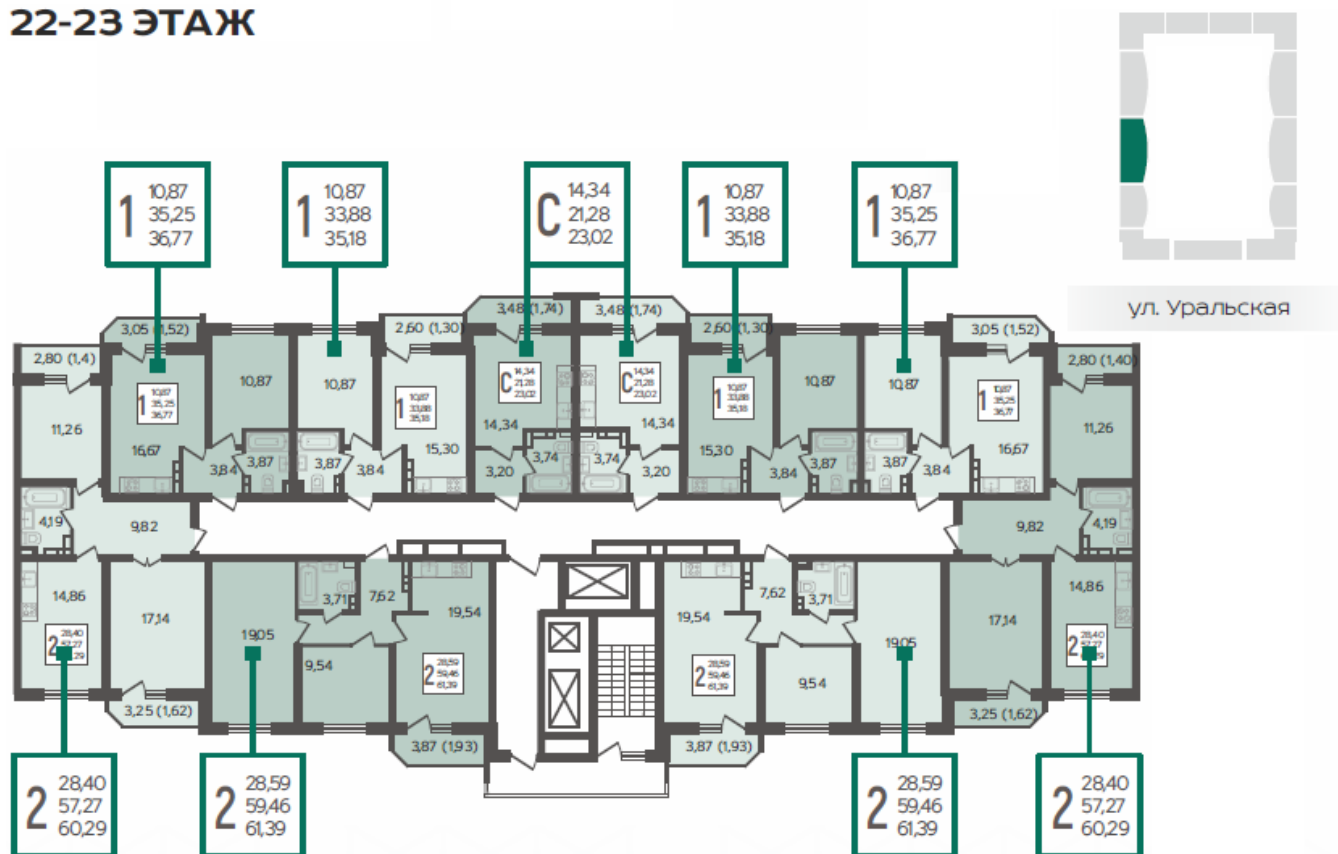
Типовой план 22-23 этажа БС-3 ЖК URAL
